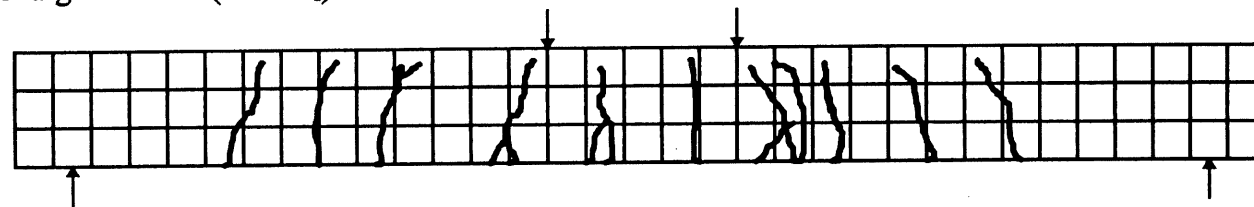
Réseau de fissuration de la poutre S500A
